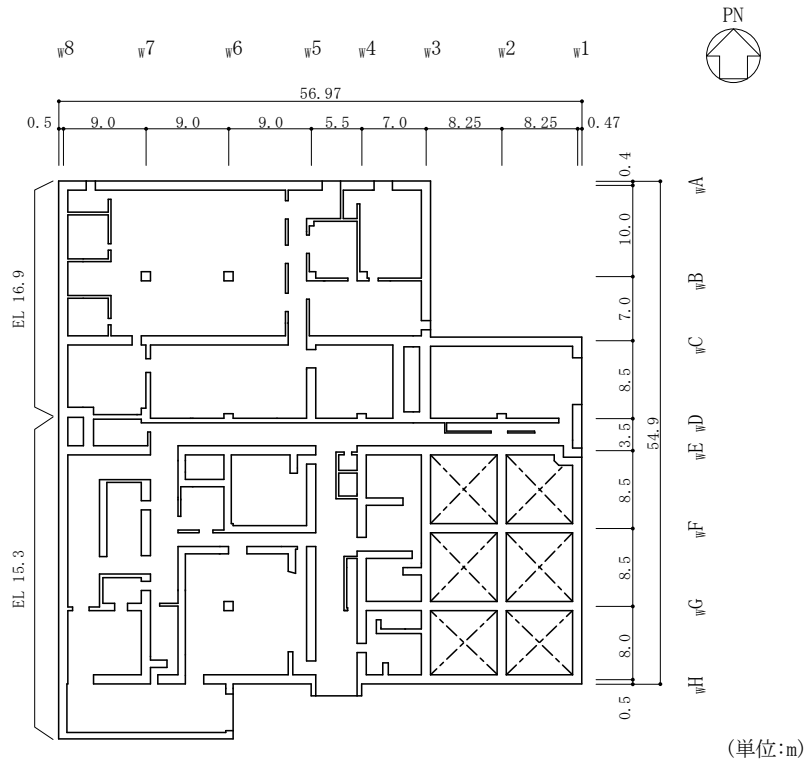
(4) 廃棄物処理建物の概略平面図 (EL 15.3m, EL 16.9m)
